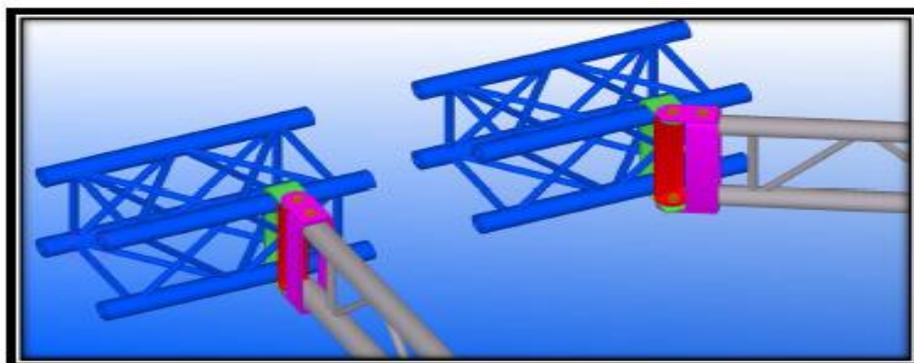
Ejemplo de detalles de unión Truss 3D (fuente: propia)
